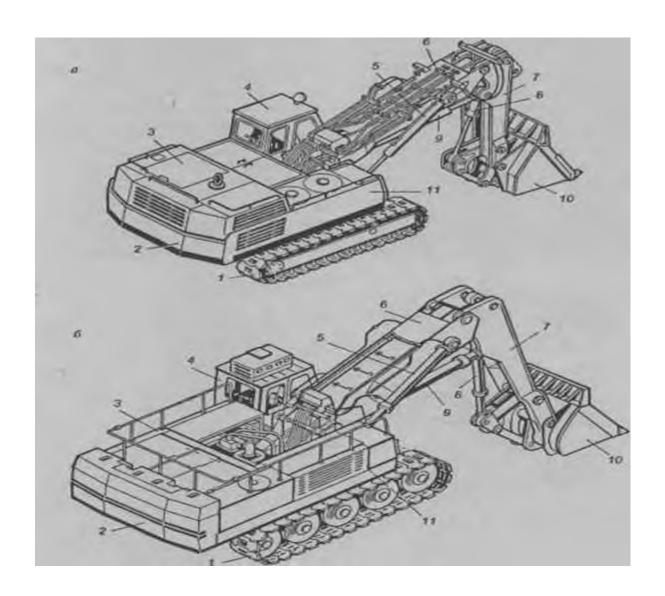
а. Гусеничные гидравлические экскаваторы 3-й и 4-и размерных групп: а -ЭО-3122: 1 - гусеничное ходовое устройство; 2 - поворотная платформа; 3 - силовая установка; 4 - кабина; .5 - моноблочная стрела: 6 7, 10 - гидроцилиндры рукояти, ковша и стрелы; 8 - рукоять; 9 - ковш обратной лопаты; 11 - опорно-поворотное устройство; 12 базовая часть стрелы; 13 - головная часть стрелы.
